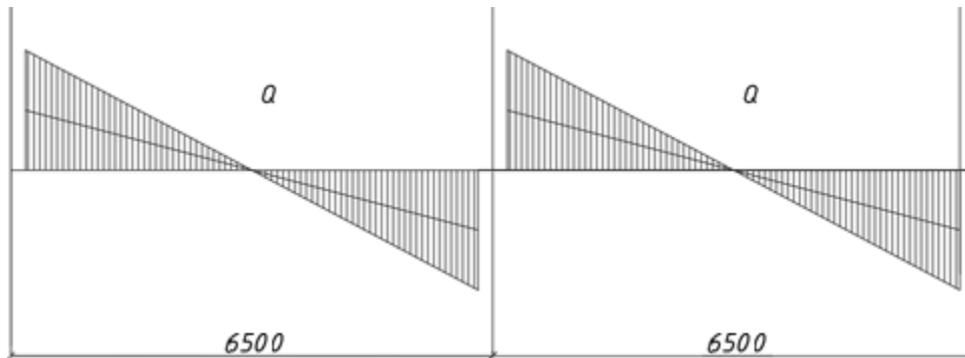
Схема фрагмента монолитной плиты перекрытия в осях 4-5 и рядах Б-В с опирание на колонны при определении действующих поперечных сил.
